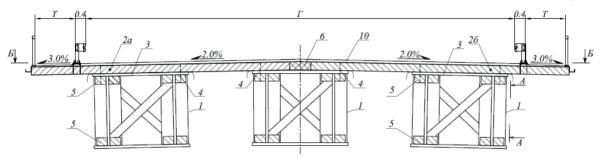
Пролетное строение с железобетонной плитой проезжей части
